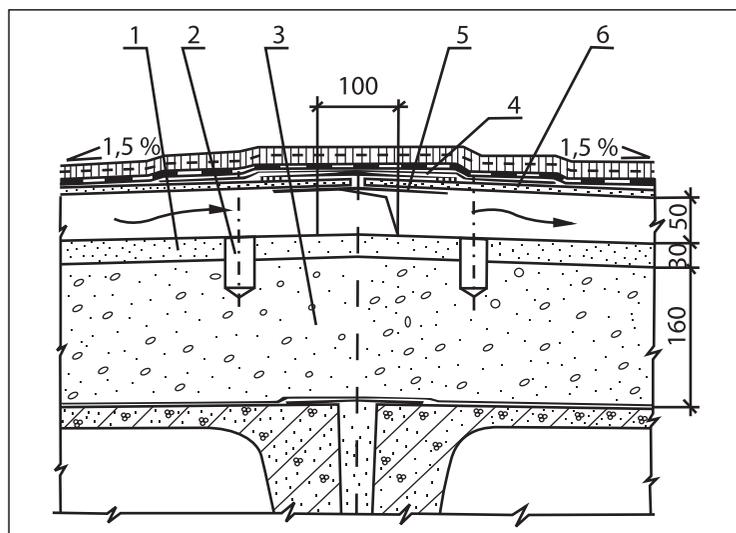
Пример решения конька крыши с дополнительным утеплением одним слоем минераловатных плит и объединяющим каналом 100 мм: 1 – стяжка из цементно-песчаного раствора; 2 – перфорация стяжки; 3 – увлажненный пенобетон; 4 – полоса кровельного материала над стыком асбестоцементных листов; 5 – подкладка под кромки консольной части листов 250 x 200 мм, $\delta = 0,8$ мм через 500 мм; 6 – асбестоцементные листы, $\delta = 10$ мм
